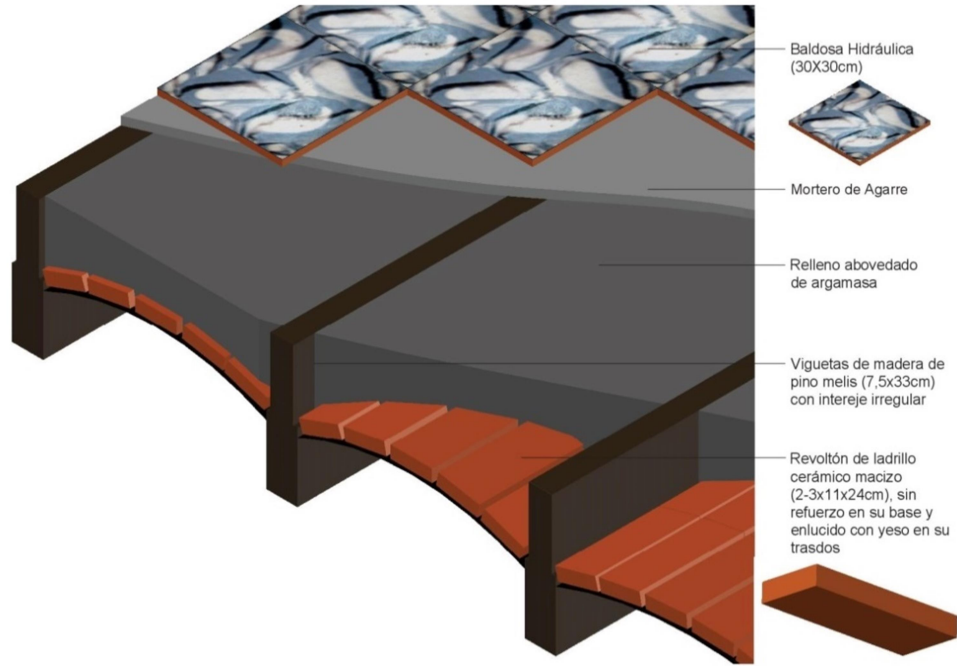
Detalle de forjado del dormitorio 2 de PB de revolvón de ladrillos con viguetas de madera maciza
